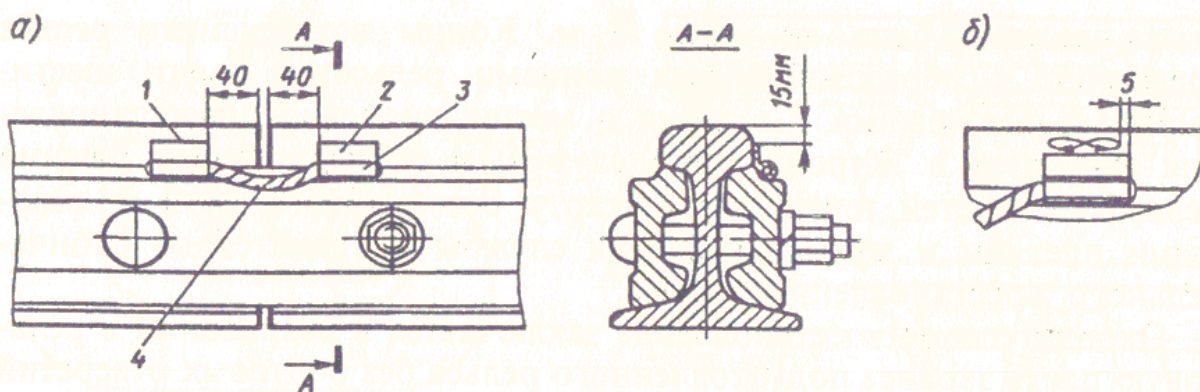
Схема установки (а) и приварки (б) медного соединителя фартучного типа к головке рельса (мм):
